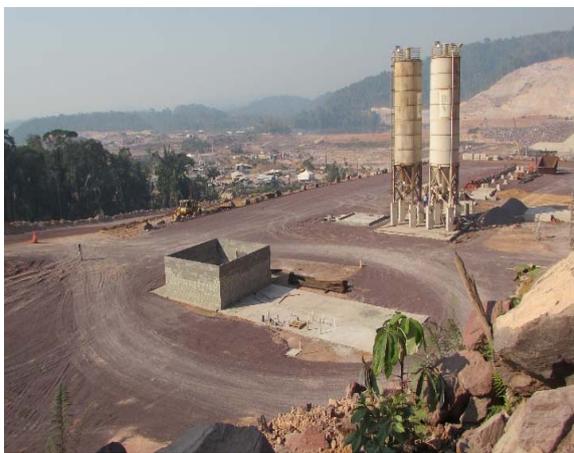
Evolução das estruturas do laboratório, para futura relocação das estruturas de trabalho.
